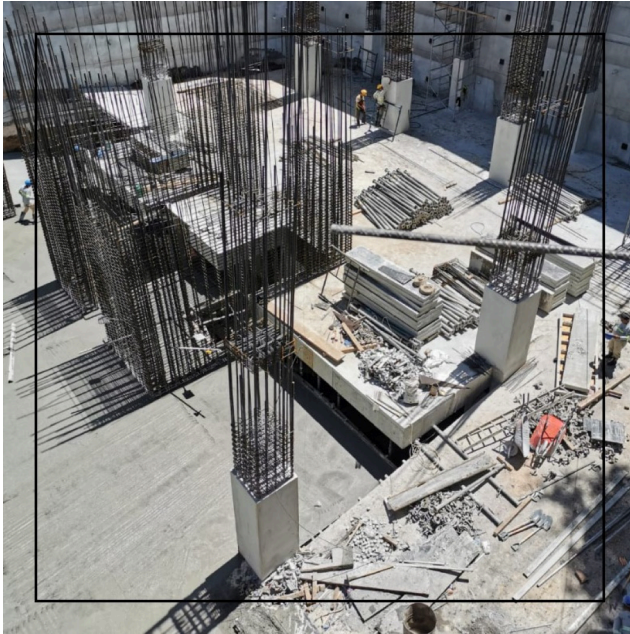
Se puede observar claramente el sistema de marcos de concreto reforzado (esqueleto interno).
